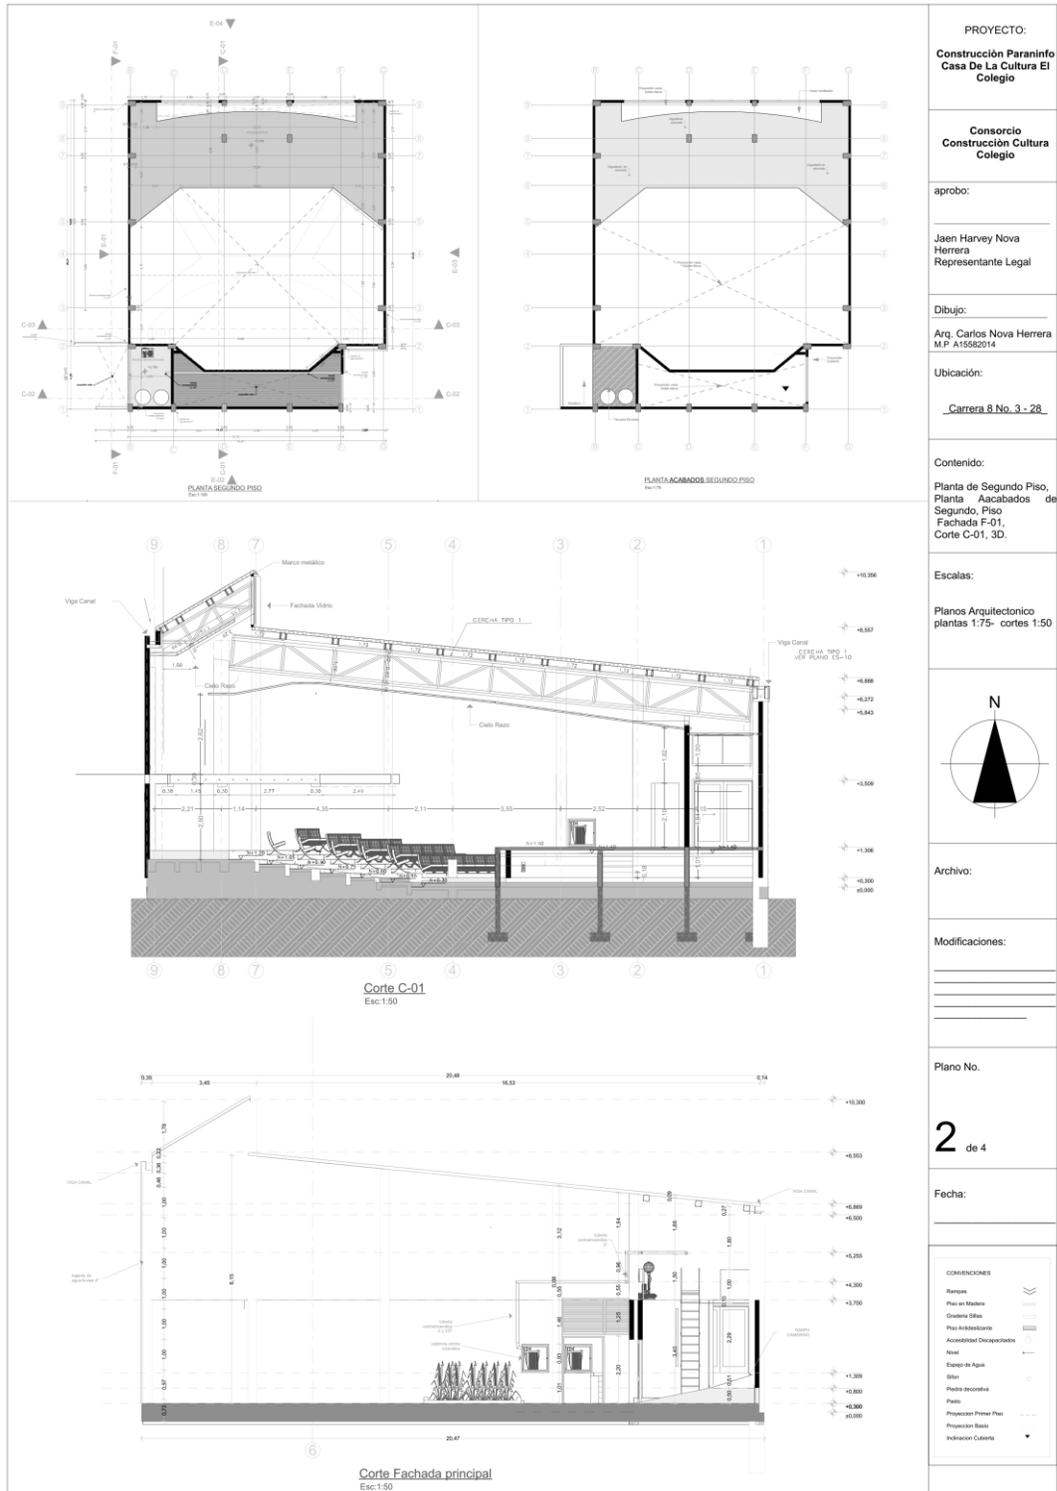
Paraninfo, Planos record, fachadas, Render/ Propio
